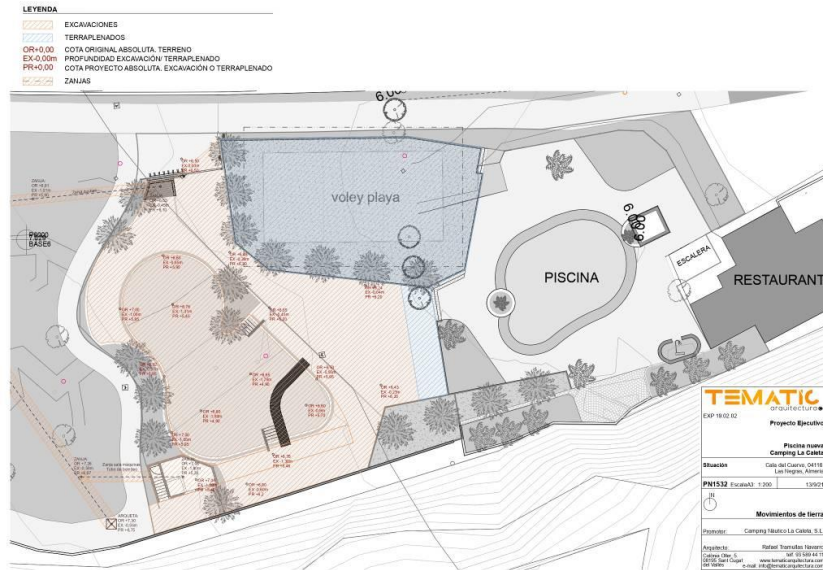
Planteamiento de piscina a construir (al oeste de la actual piscina).
